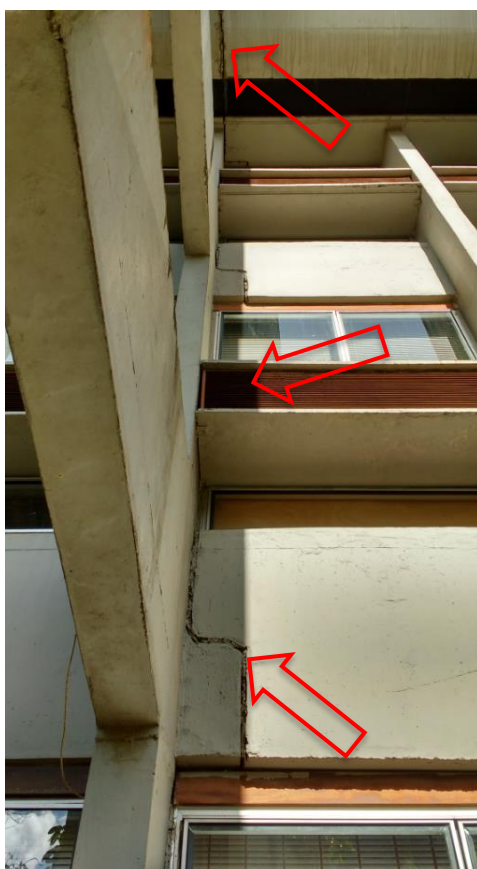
Vista externa de uma junta de dilatação: junta na platibanda e nas vigas (console e dente gerber íntegros, sem fissuras).
